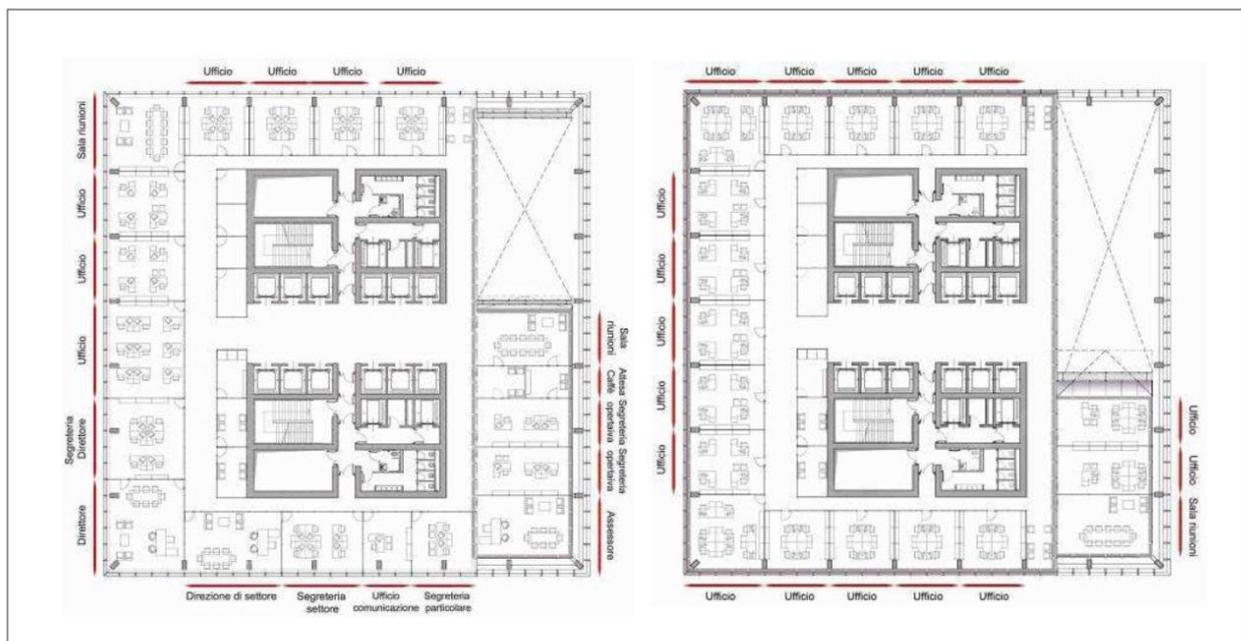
Pianta piano tipo standard (a sinistra), pianta piano tipo assessorato (a destra)<sup>48</sup>
